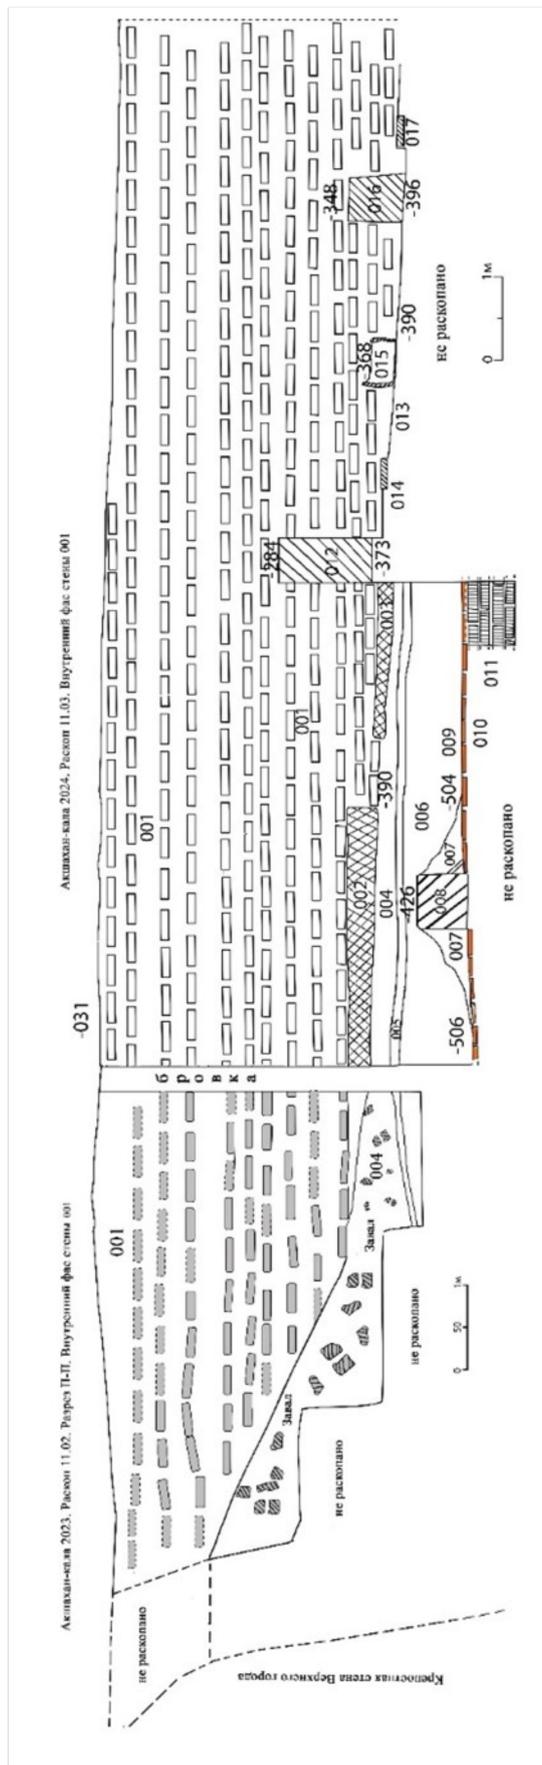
Акшхан-кала. Раскоп 11, разрез фасада оборонительной стены «цитадели».
